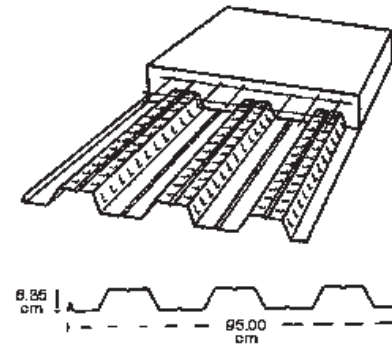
En esta imagen observamos un corte de losacero, y sus dimensiones
